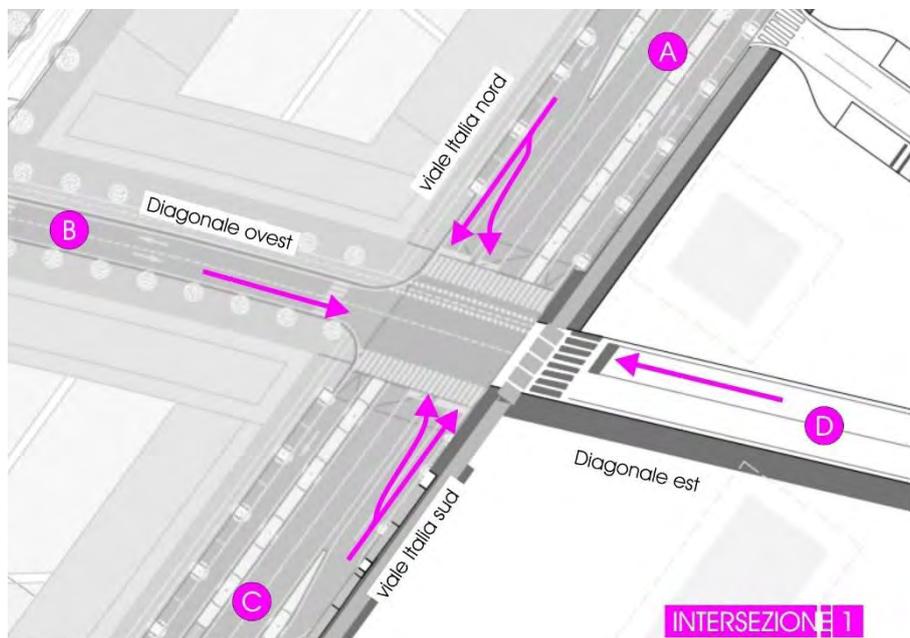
Scenario di Intervento 1 – Planimetria intersezione 1
